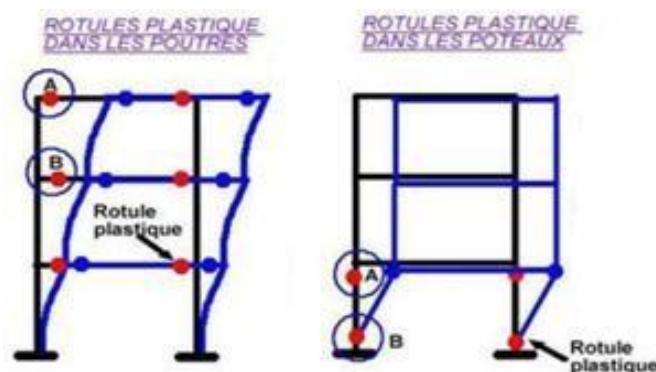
Rotules plastiques au niveau des poteaux et des poutres.
